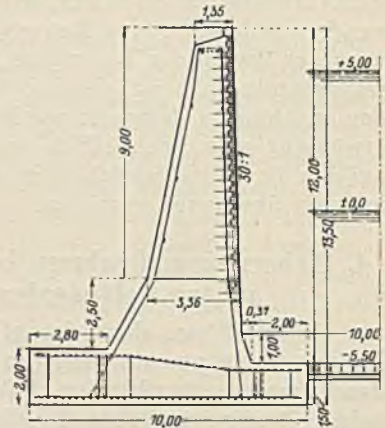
Durchbildung einer in einem Bergwerksgebiete erbauten Schleuse.
